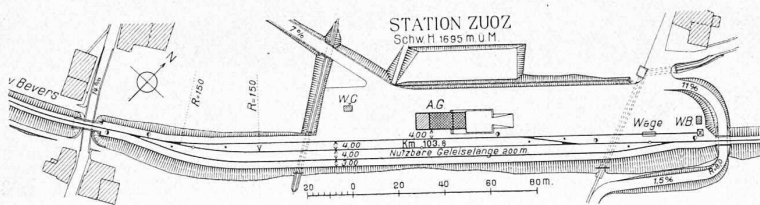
Lageplan der Station Zuoz. — 1 : 3000.
